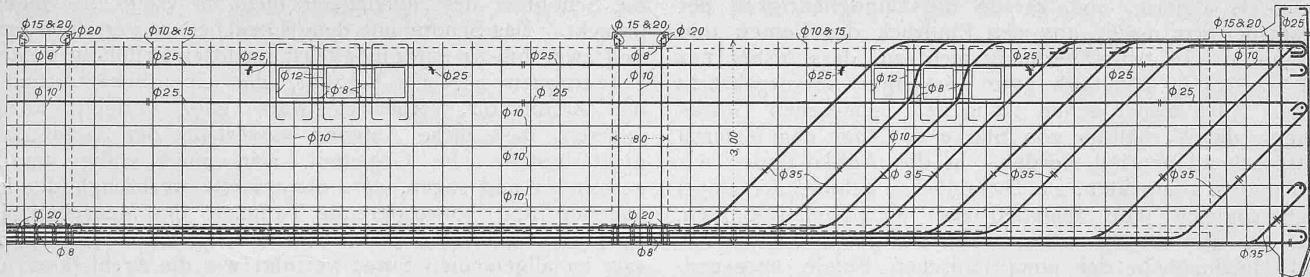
Armierungsplan der Kabelbrücke (rechte Hälfte der rechtsufrigen Brückenöffnung). — Masstab 1:100.
